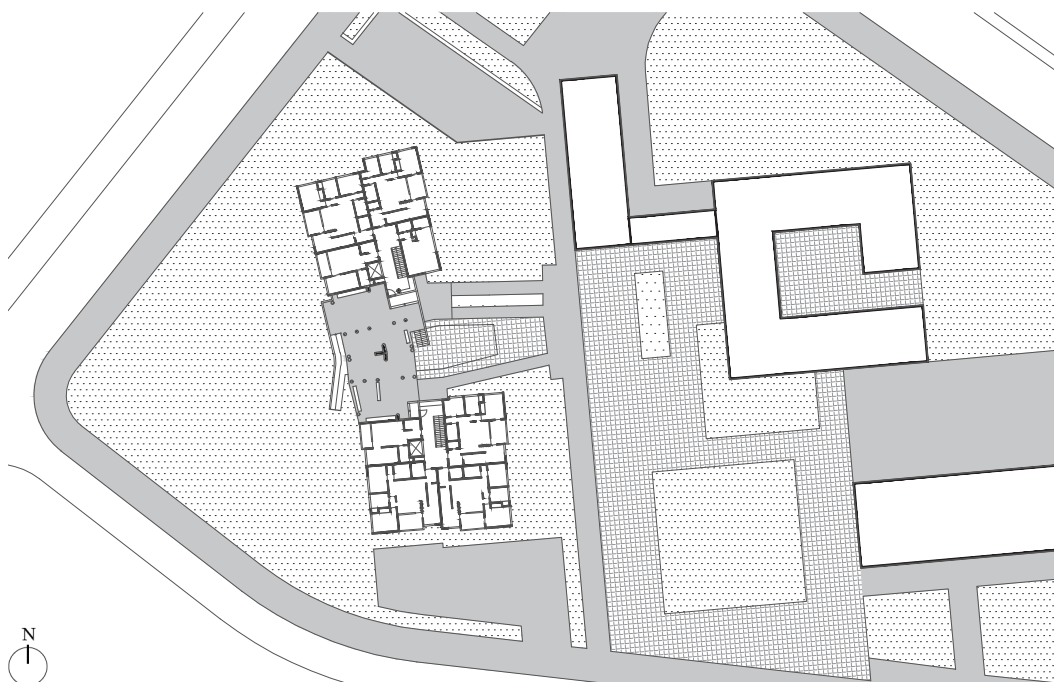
Planta de pavimentos, Hansaviertel. Escala 1:1000.
